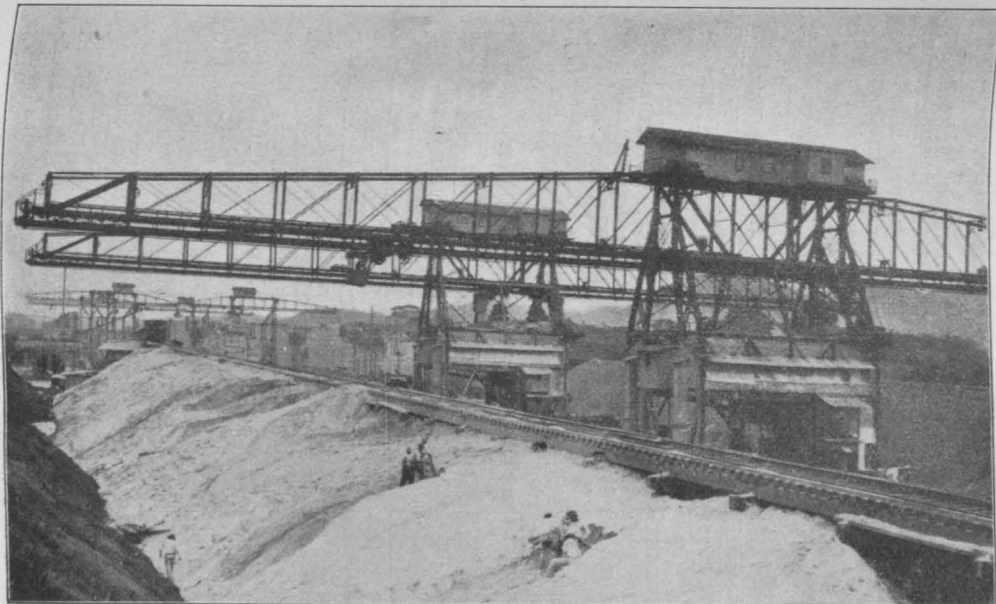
und 18. Einbringung des weichen Betons in die Schalung und Betontransport.
